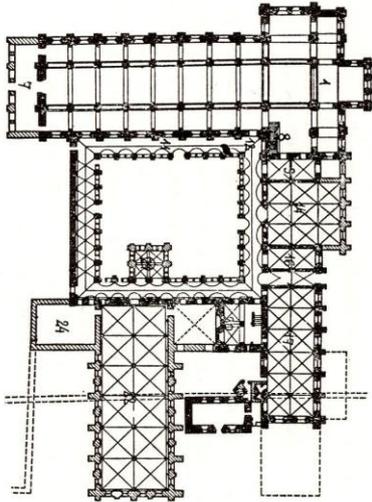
und 6 Fontenay, Grundriss des Zisterzienserklosters und Innenraum der Klosterkirche
